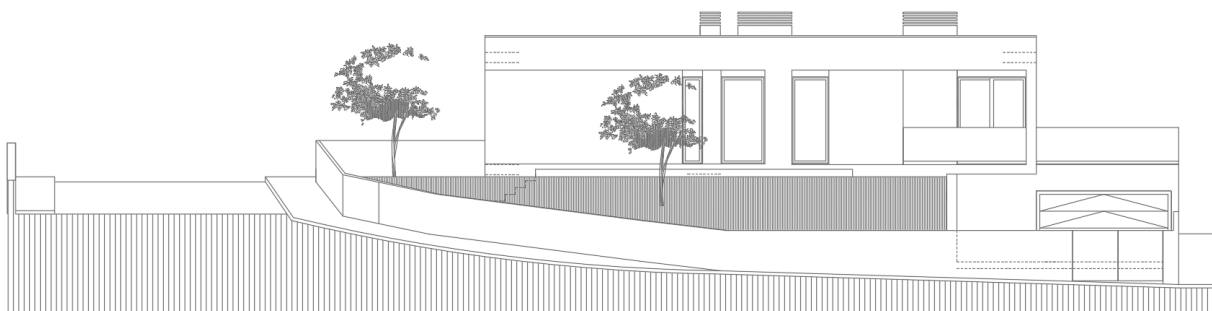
Alçado Sul (Projeto de arquitetura).
